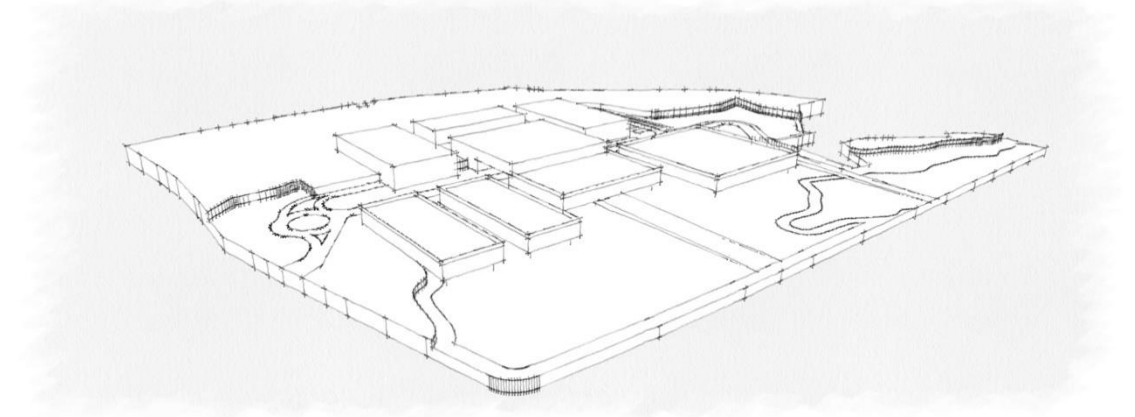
Fase inicial – primeira volumetria, modelo pavilhonar. Plano horizontal já definido.
